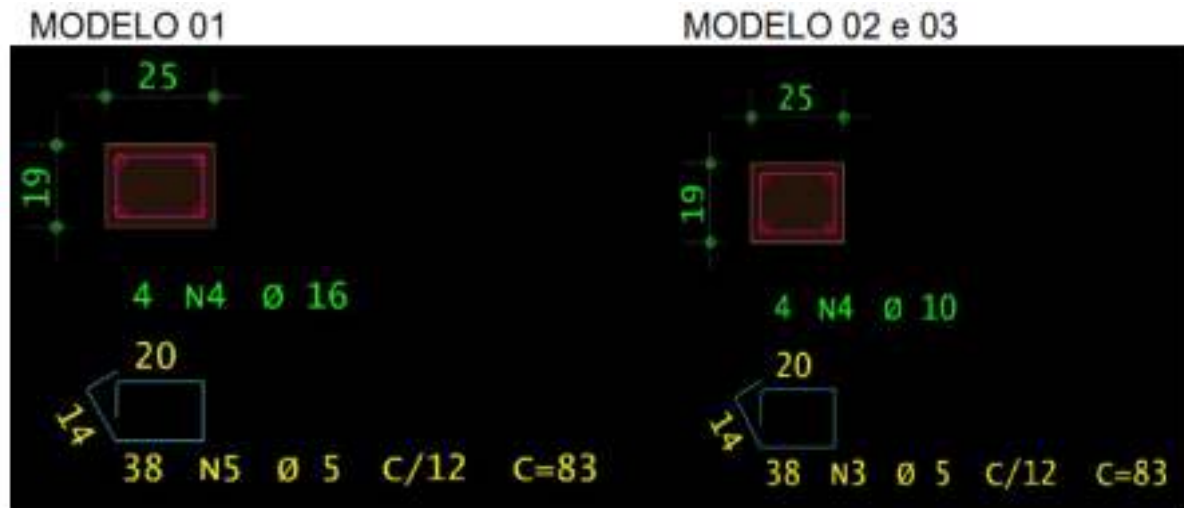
Armadura pilar P15: Modelo 01, 02 e 03
